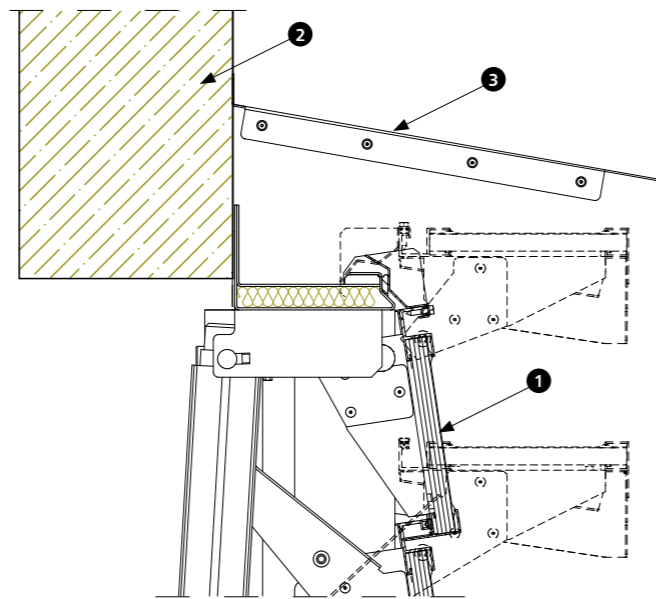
Montage des Lamellenlüfters in Maueröffnung (Wand, Fassade) von außen
